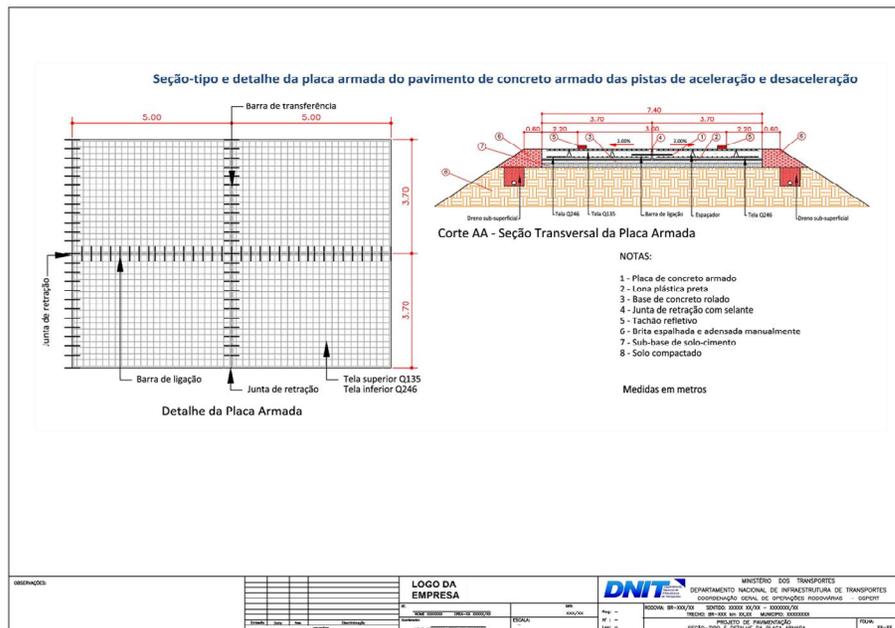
Modelo da seção tipo de Pavimentação e detalhe da placa armada*.
